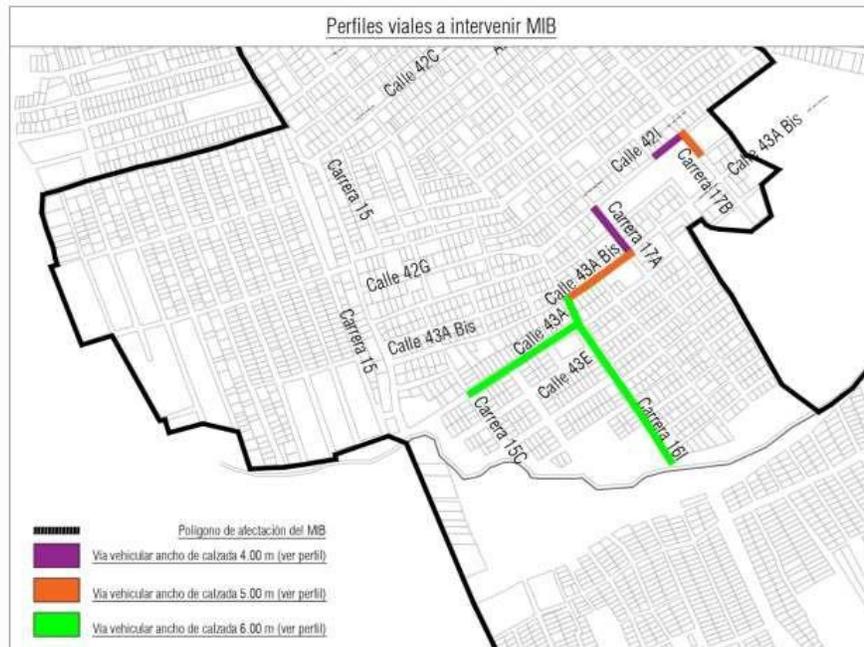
Plano en planta con las características de los perfiles viales a intervenir, propuestos por la Alcaldía de Sincelejo.
